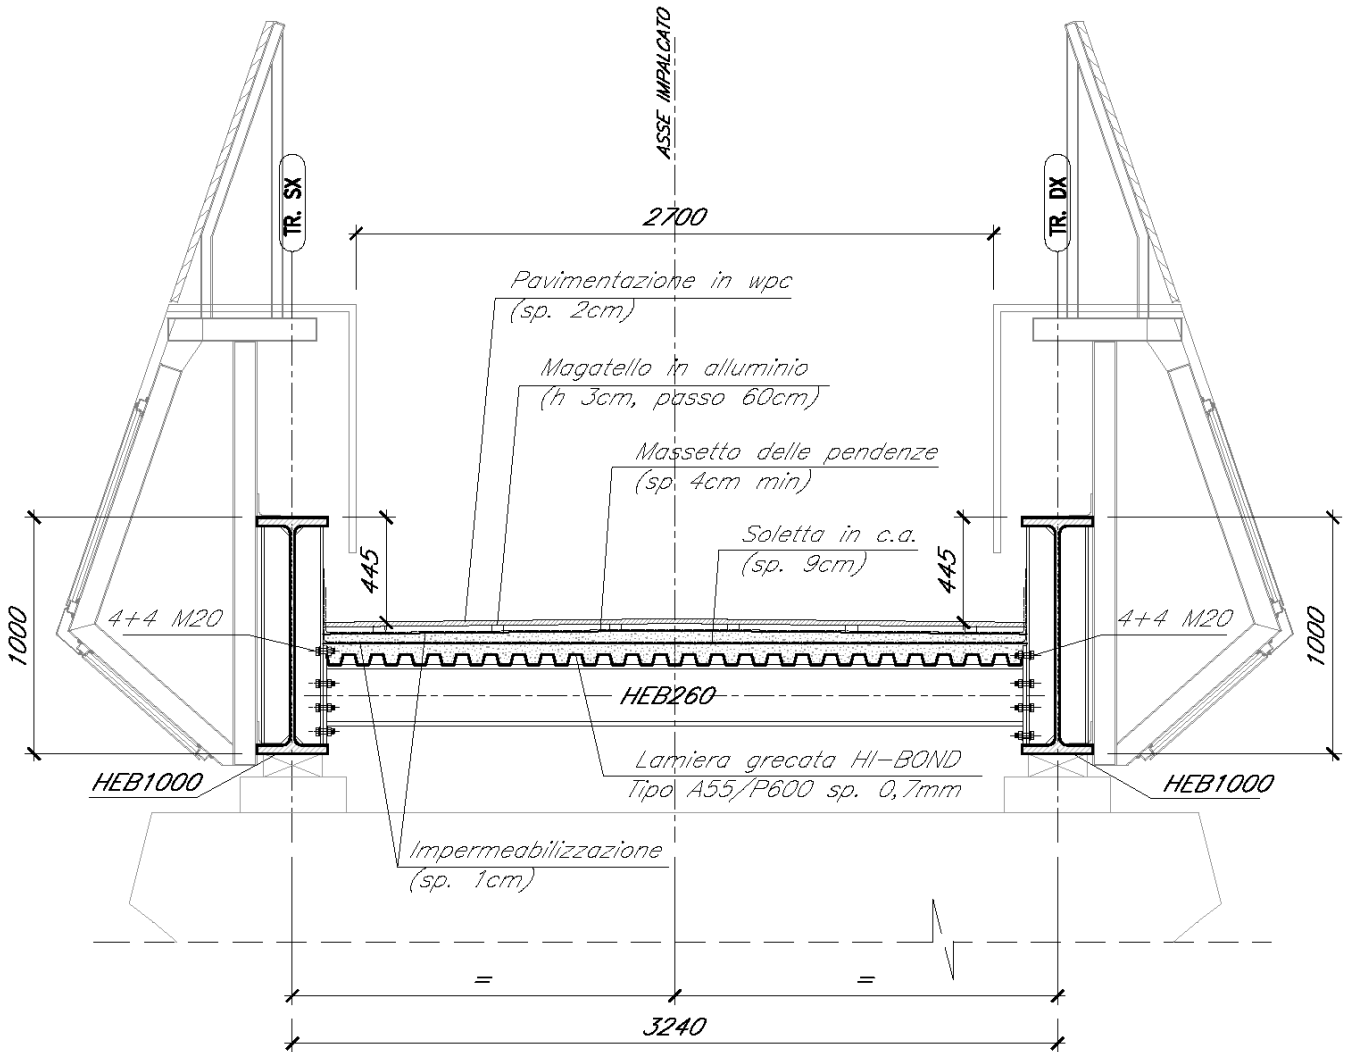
Sezione trasversale dell'impalcato in asse appoggio [mm]
